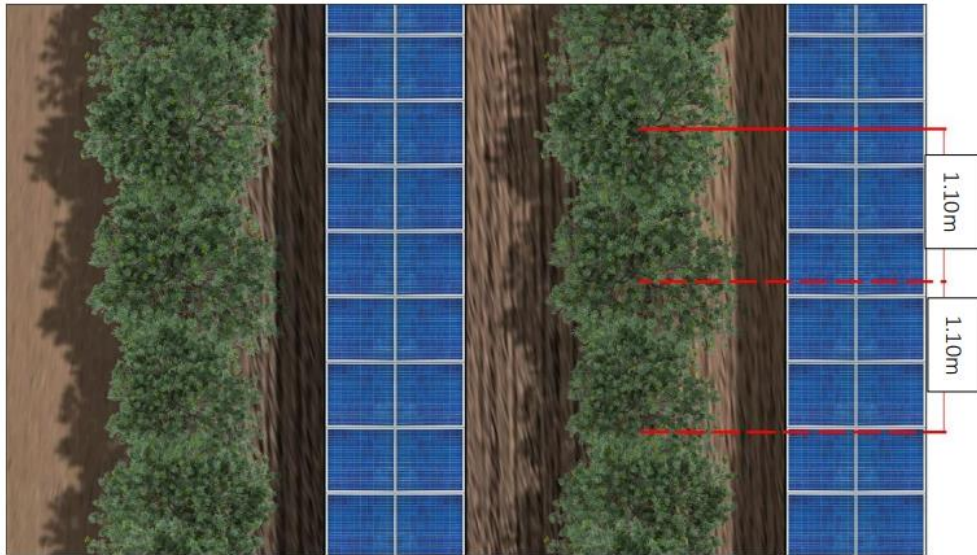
Tipologico – Vista Planimetrica dell’impianto Olivicolo.
